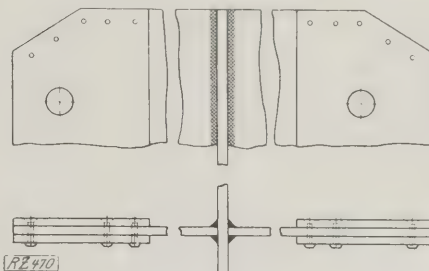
Zwei Bleche durch Schweißung mit dem senkrechten Blech verbunden.
